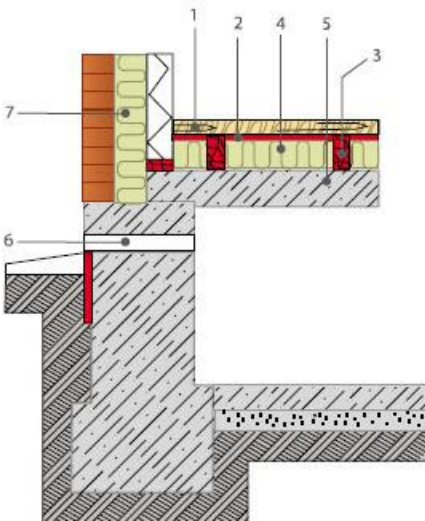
Утепление перекрытия по деревянным балкам над вентилируемым подвалом
